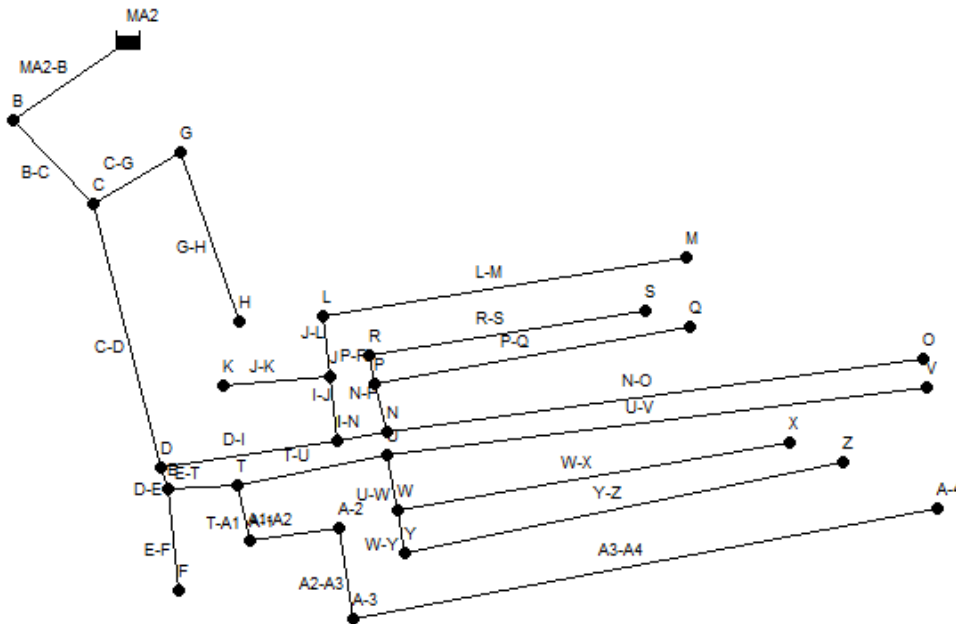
Rencana Jaringan Perpipaan SPAM 1
